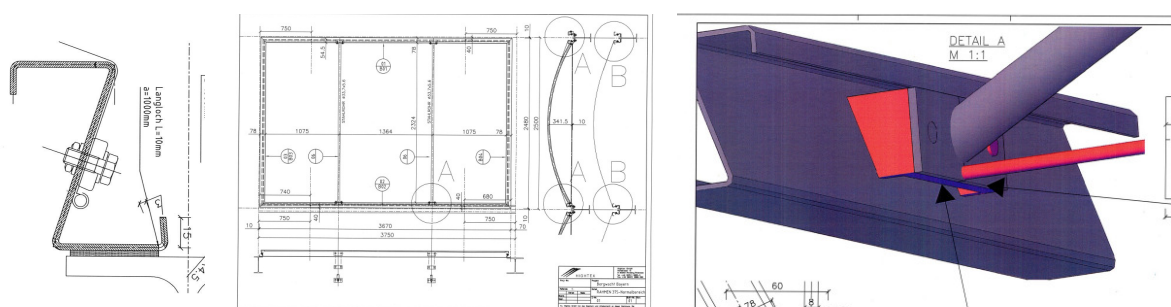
Profilschnitt, Grundriss, Ansichten und Isometrie der Bergwacht Rahmenmodule.
